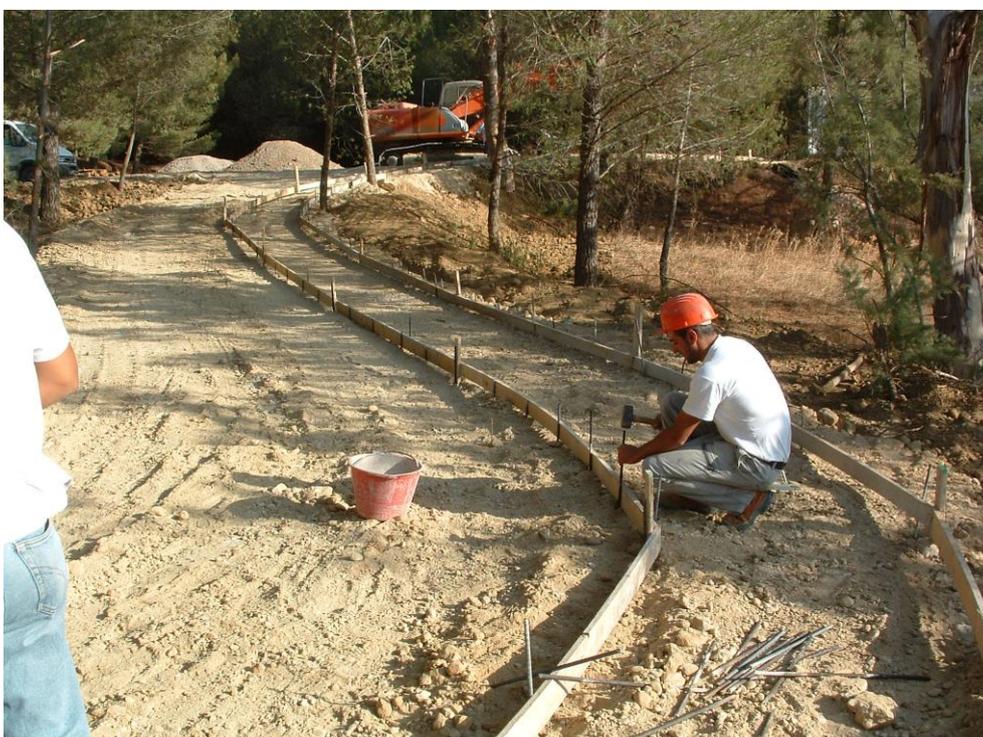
Sistemazione dell'armatura per il getto della pavimentazione ecologica .
